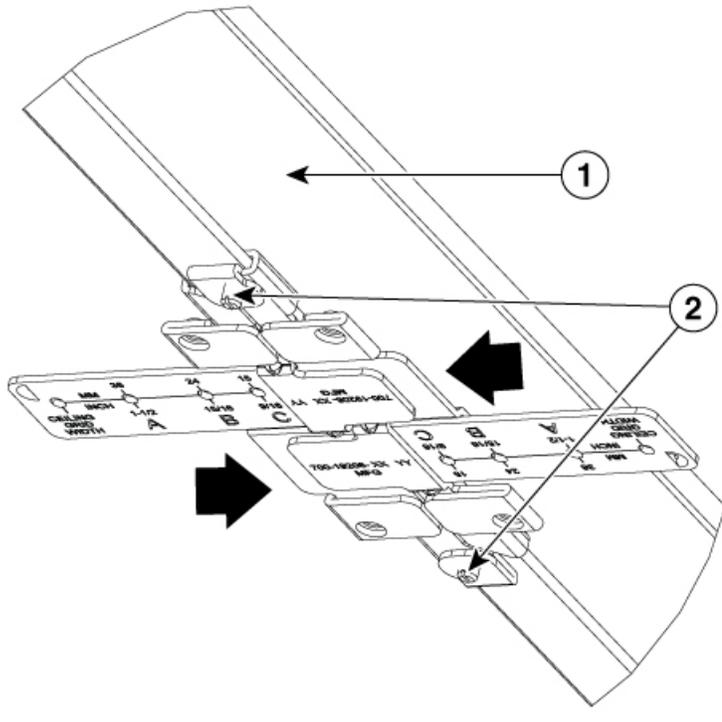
Abrazaderas para techo de rejilla completamente abiertas [AIR-AP-T-RAIL-F]
